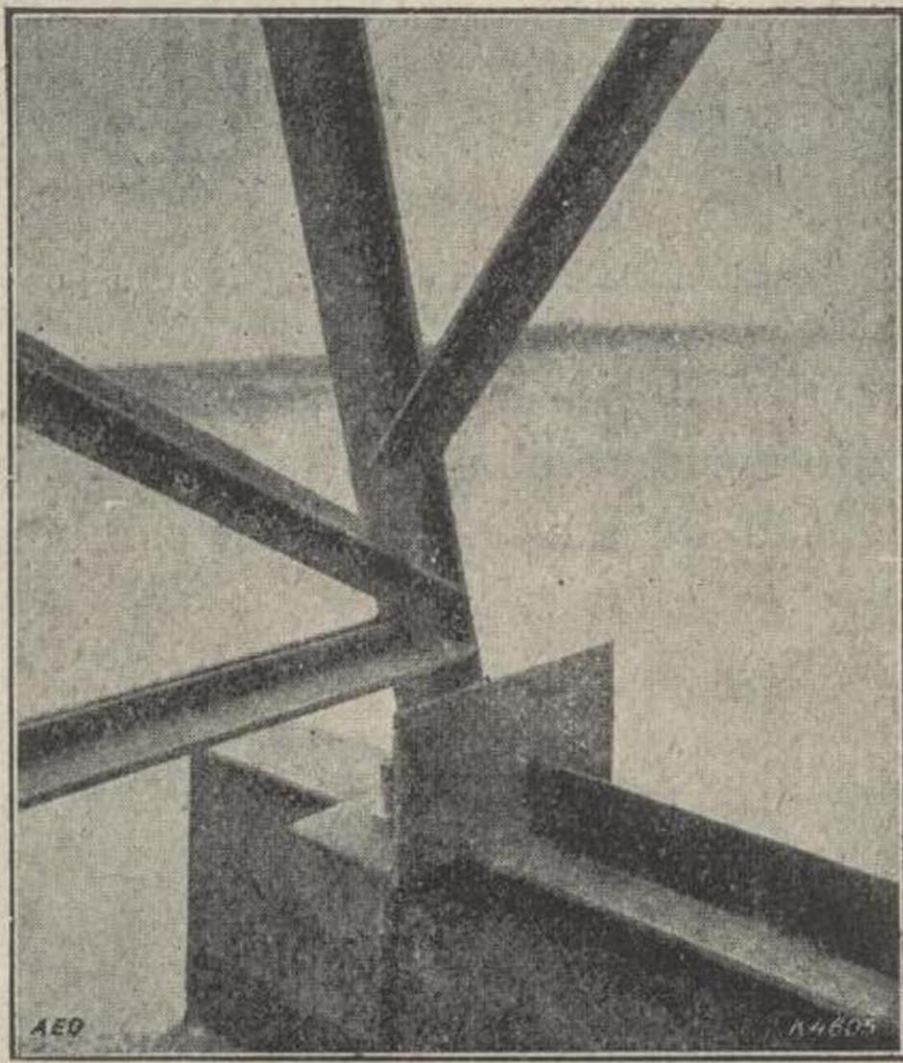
Uniones en construcciones de hierro efectuadas con soldadura por arco.
